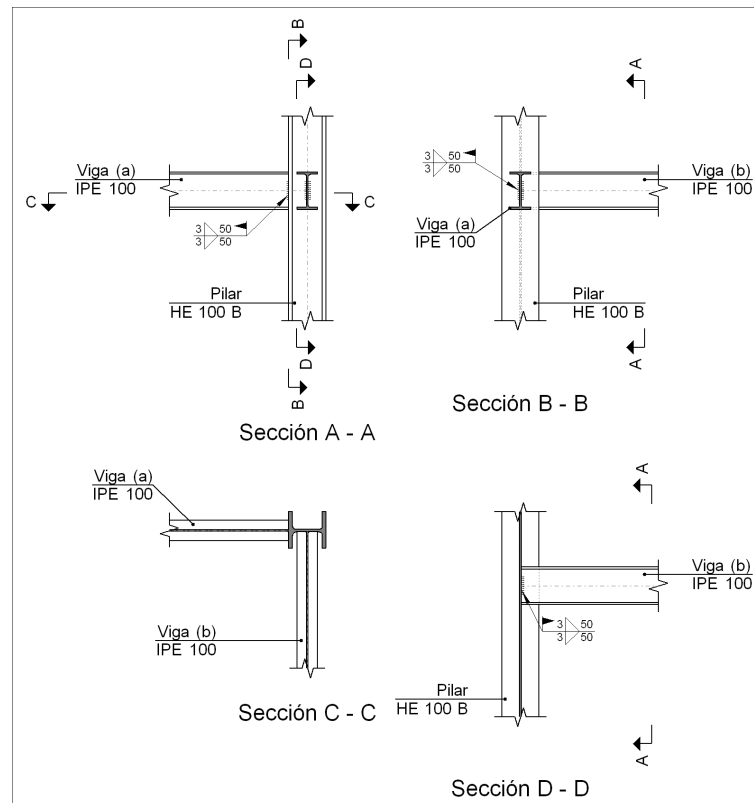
Detalle de las soldaduras tipo 2 de la estructura inferior de las escaleras
